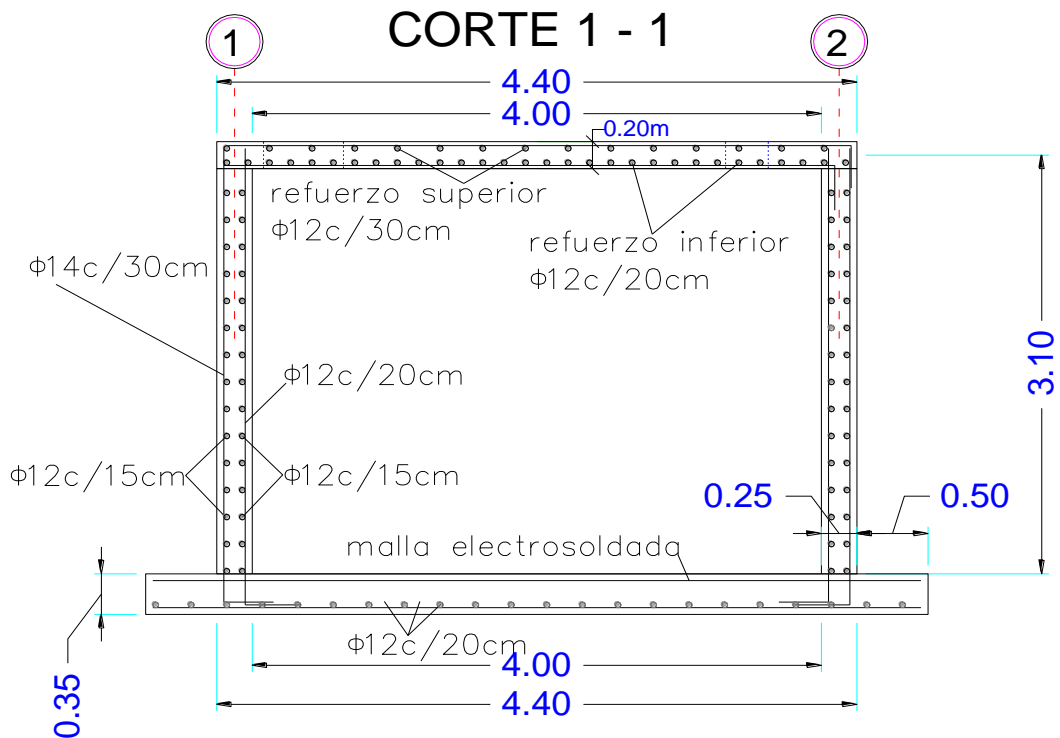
Se describen los aceros de refuerzo de la cubierta, los muros y de la losa cimentación.
